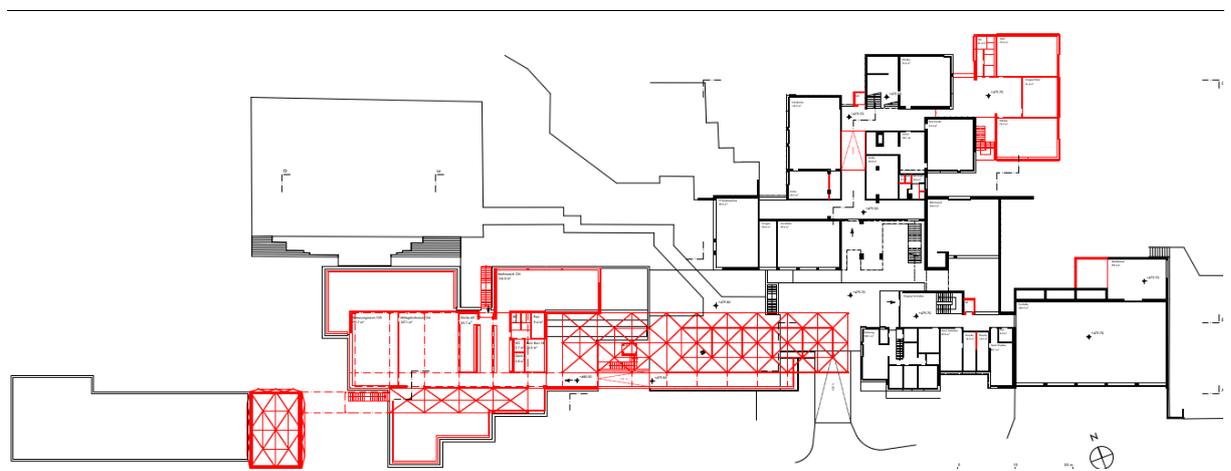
Ebene 02 Grundriss Dachaufbau Primarschule / Terrasse / UG Sekundarschule
